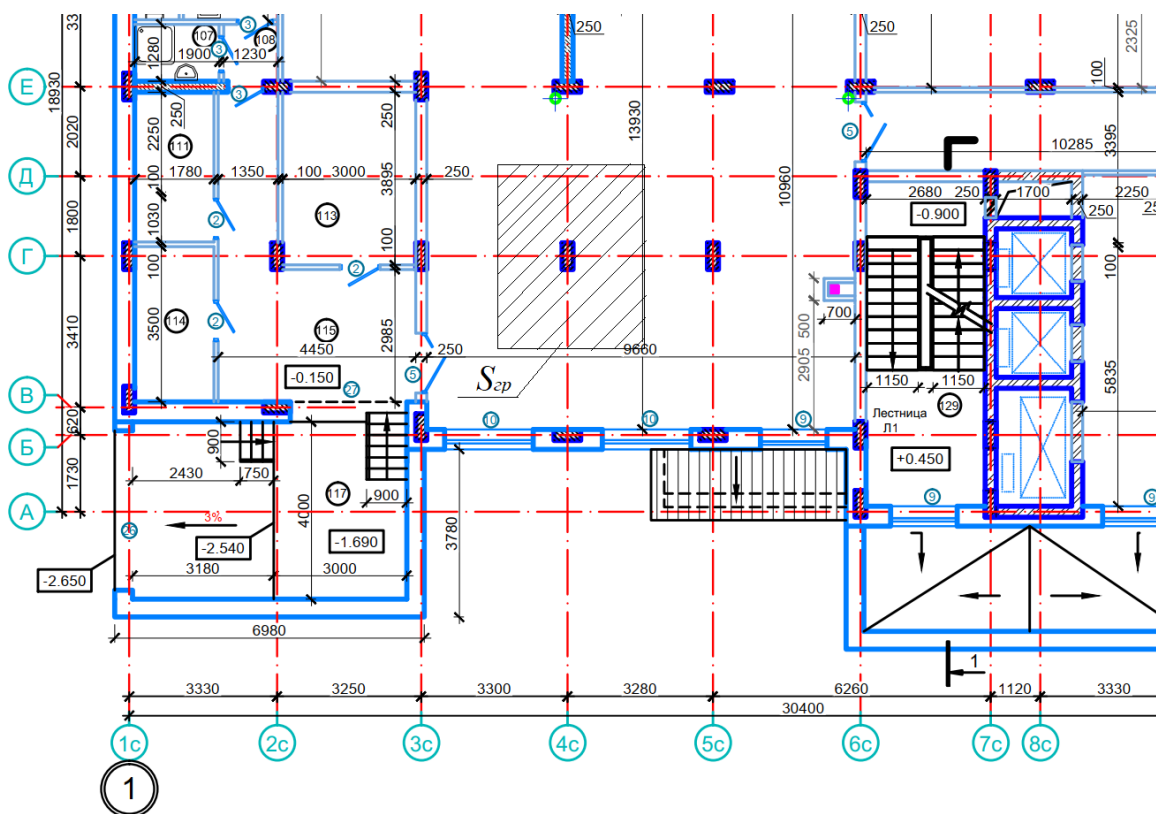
Грузовая площадь колонны 1-го этажа в осях 4С-Г
